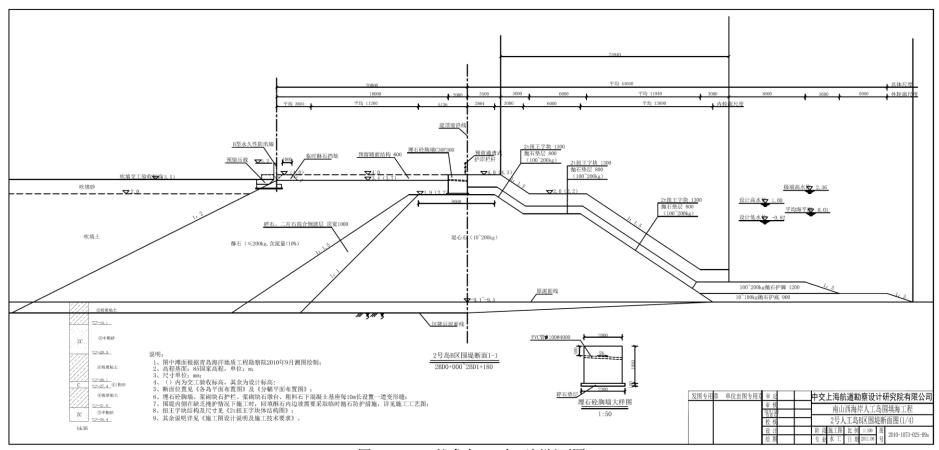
裕龙岛 2B 岛西侧断面图
